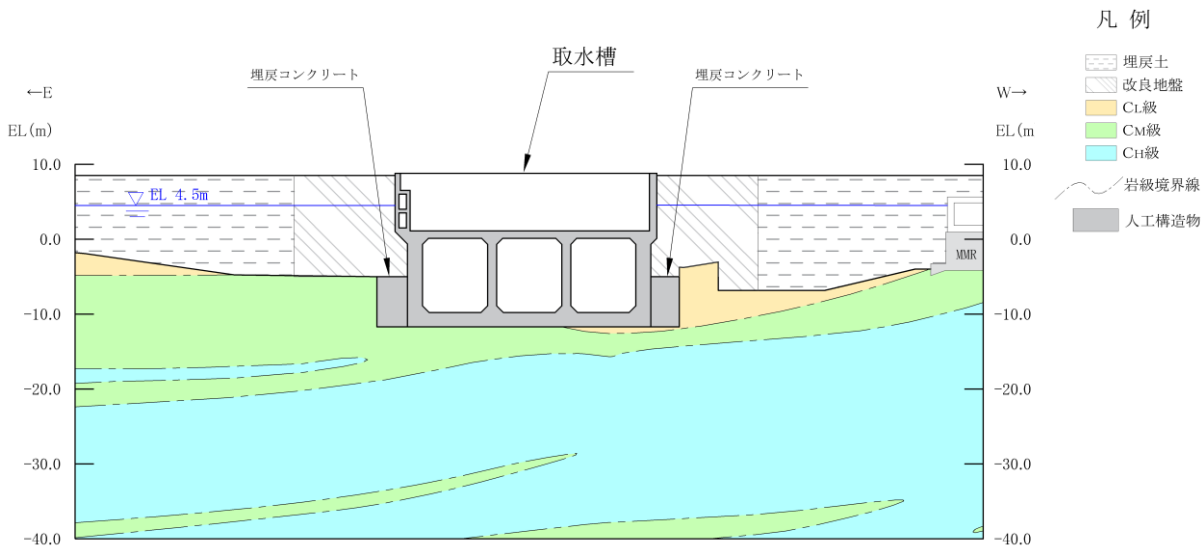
取水槽 地震時荷重算出用地質断面図 (B-B 断面)
